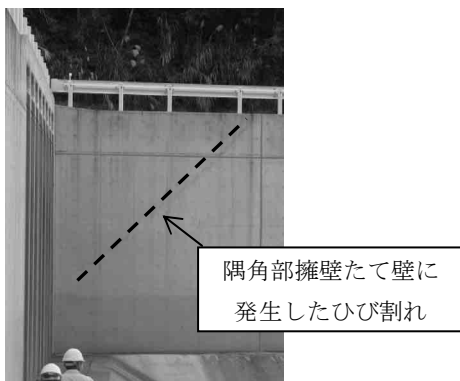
隅角部たて壁のひび割れ発生状況
